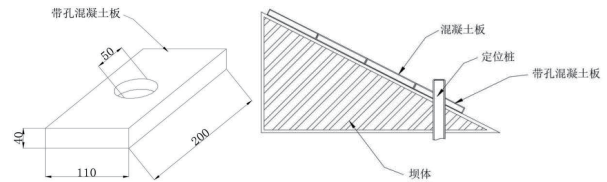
错位接缝的水库大坝防渗加固施工方法的带孔混凝土板结构示意图
